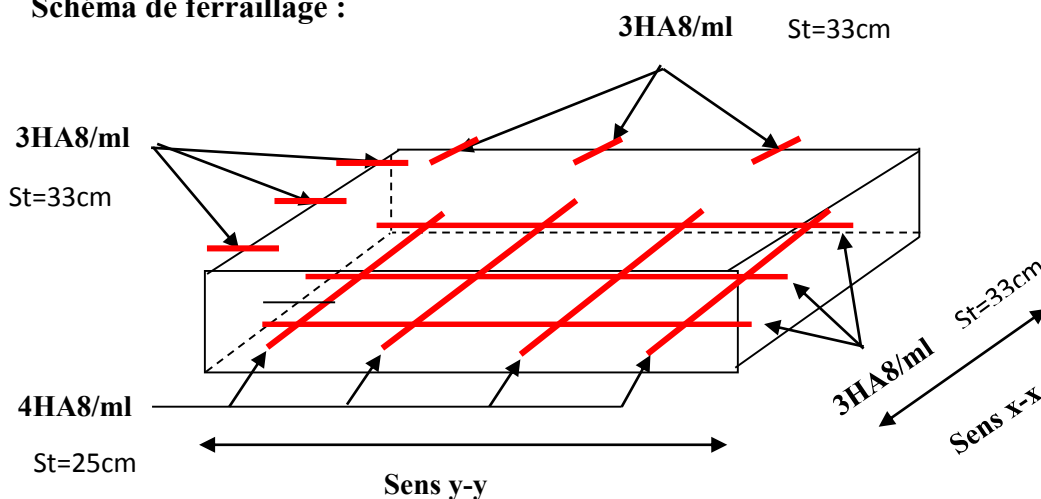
Schéma de ferrailage de la dalle pleine du local machine.
